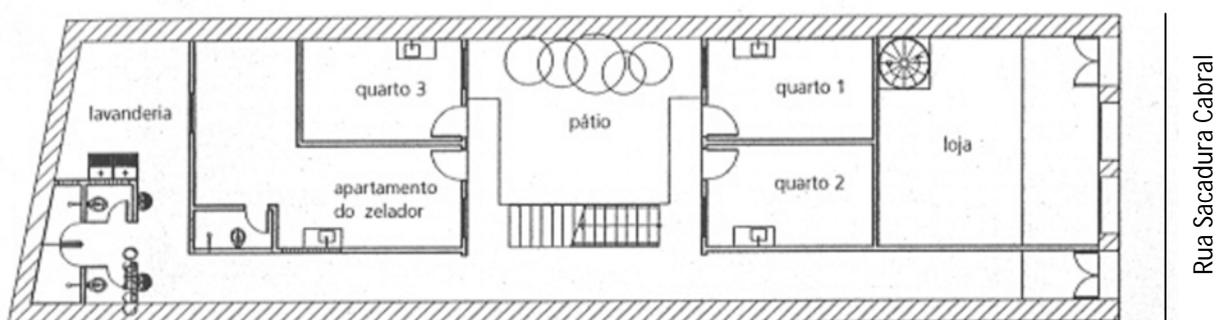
Planta do pavimento inferior. PREFEITURA, 2003.
